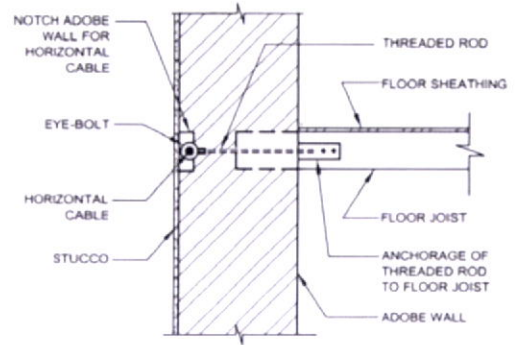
Pormenor de execução da fixação de pavimentos de madeira.
